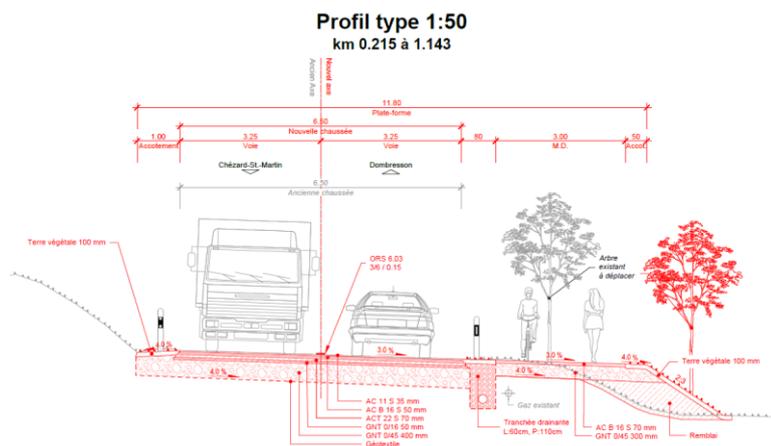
coupe type (source plan AJS 09.0000/3001)
